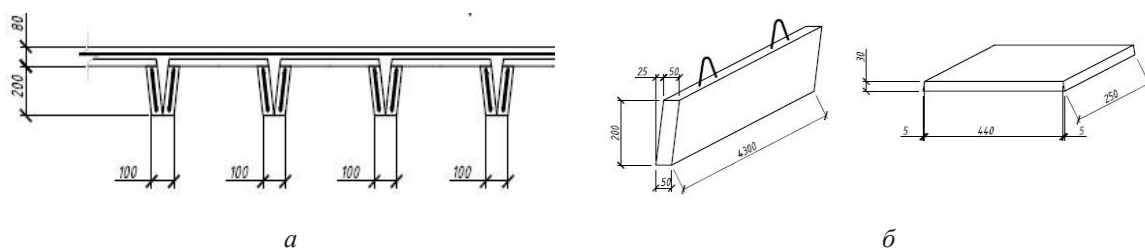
Переkritтя зі збірних залізобетонних плиток та балок:
